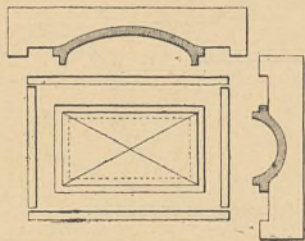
Disposition des trousses et règles pour trousser un carré ou rectangulaire.
